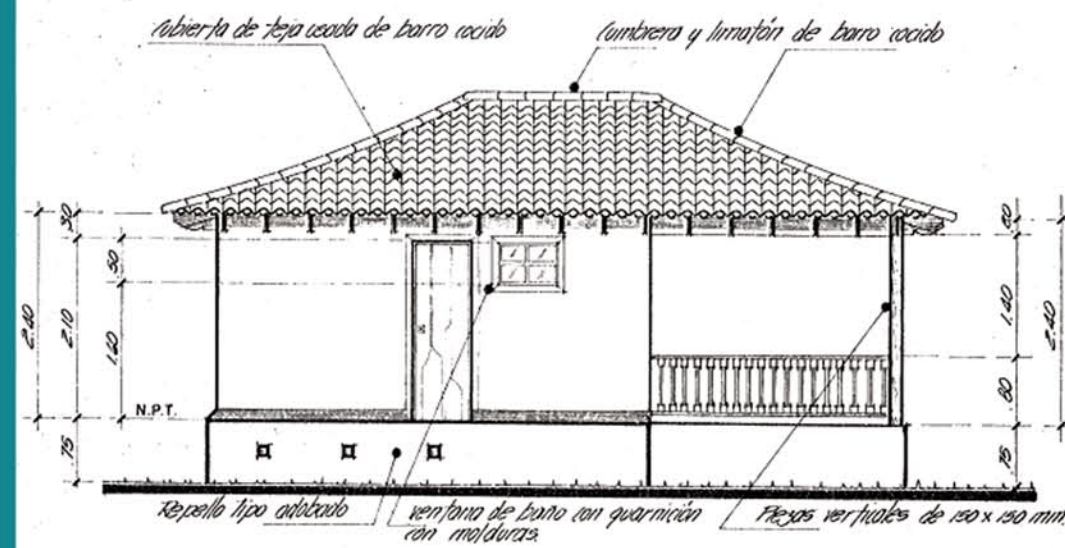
Planta Arq. Casa Guarda Ruinas de Ujarrás
